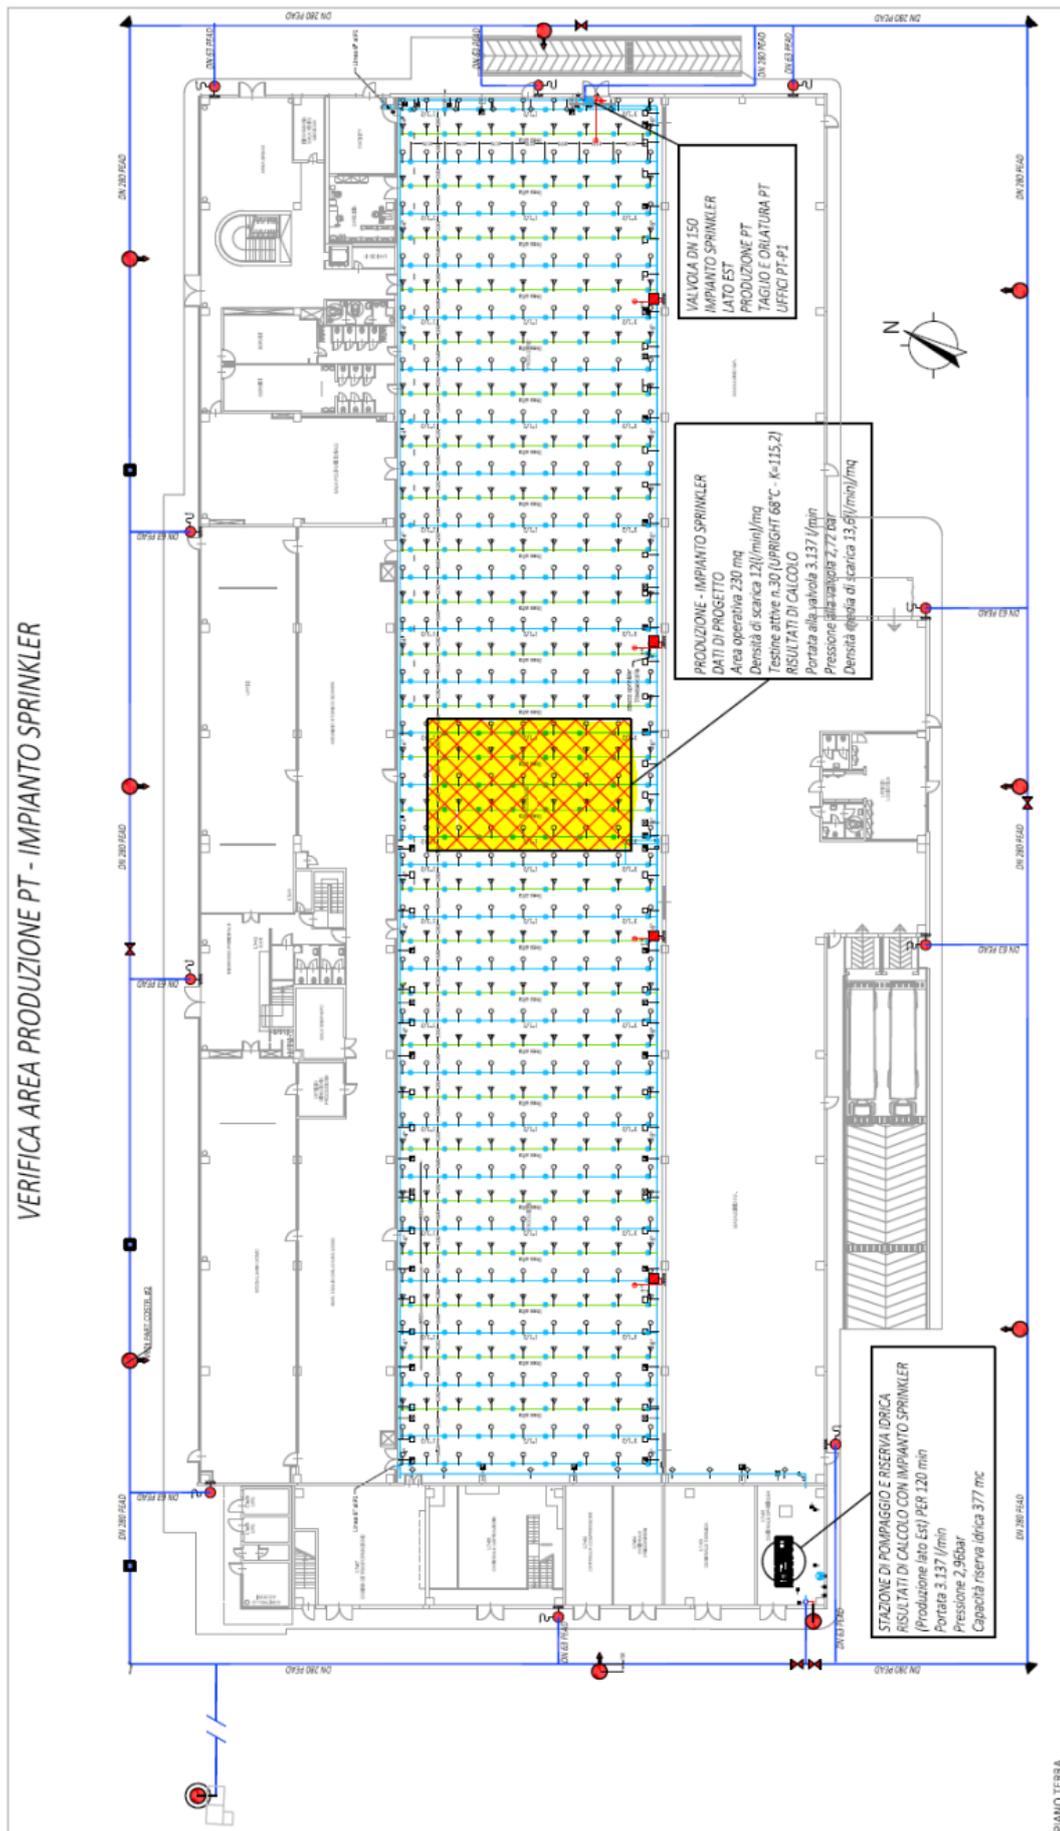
Planimetria area oggetto di verifica calcolo 3
